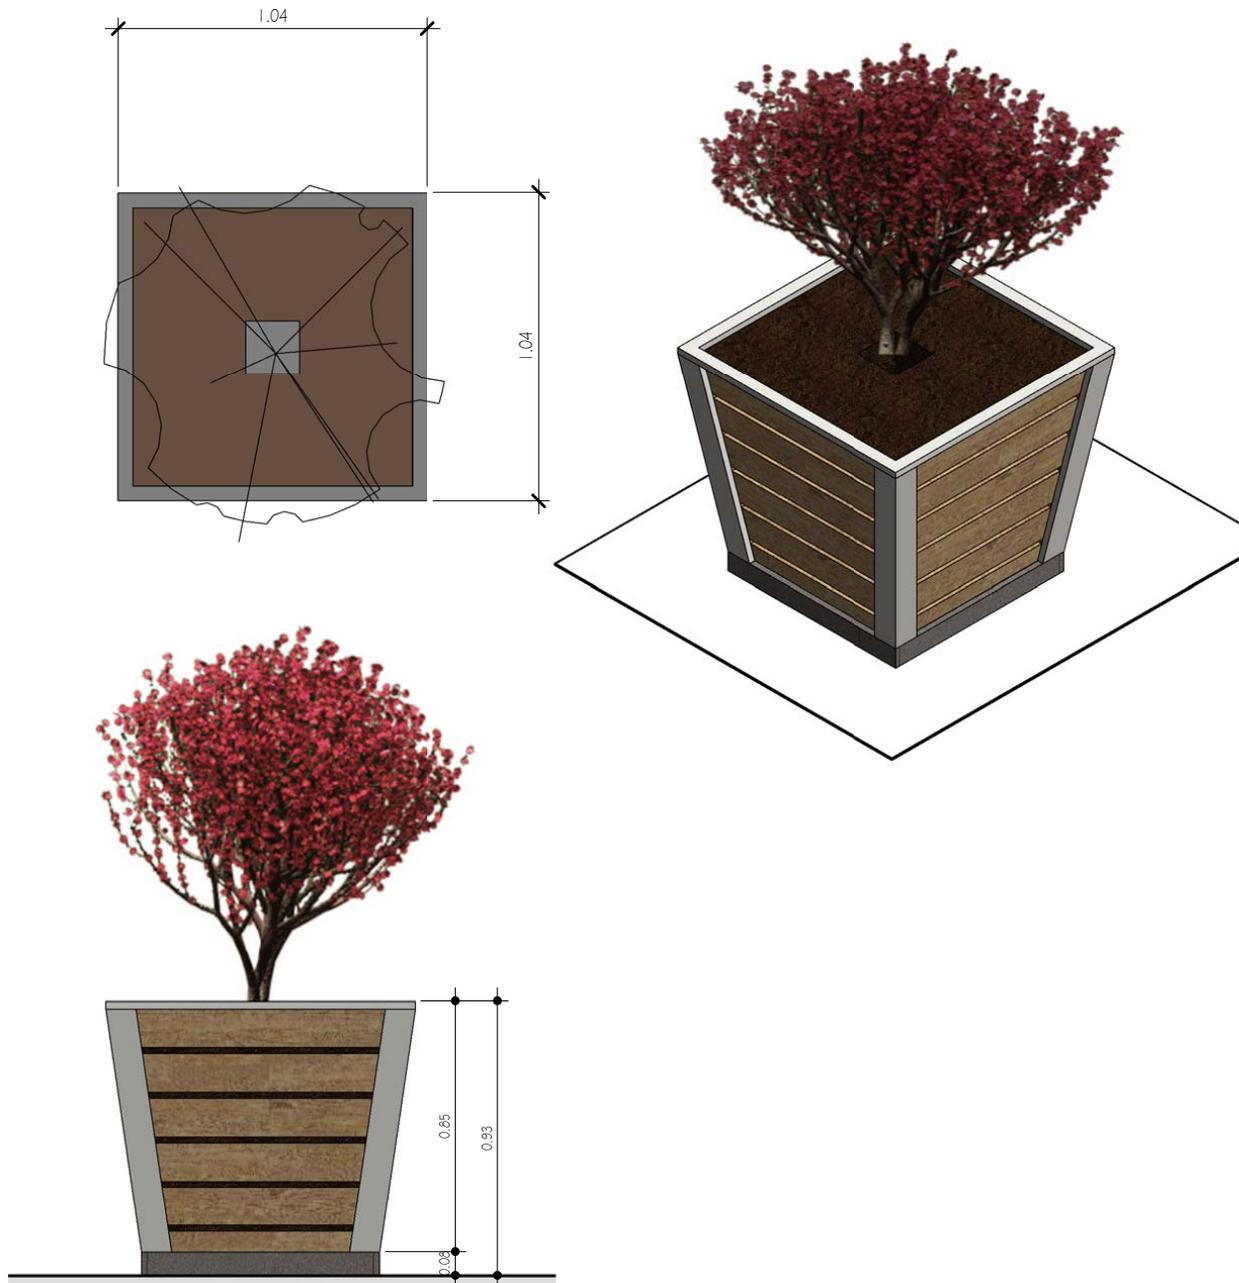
Sección Transversal de maceta BSM. Elaboración: propia.
